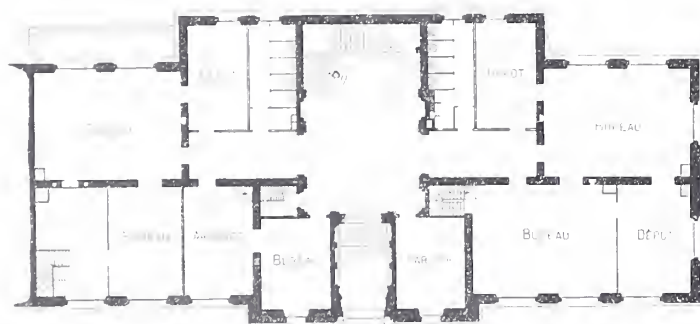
Plan du Rez-de-Chaussée. — Echelle 1:500.
